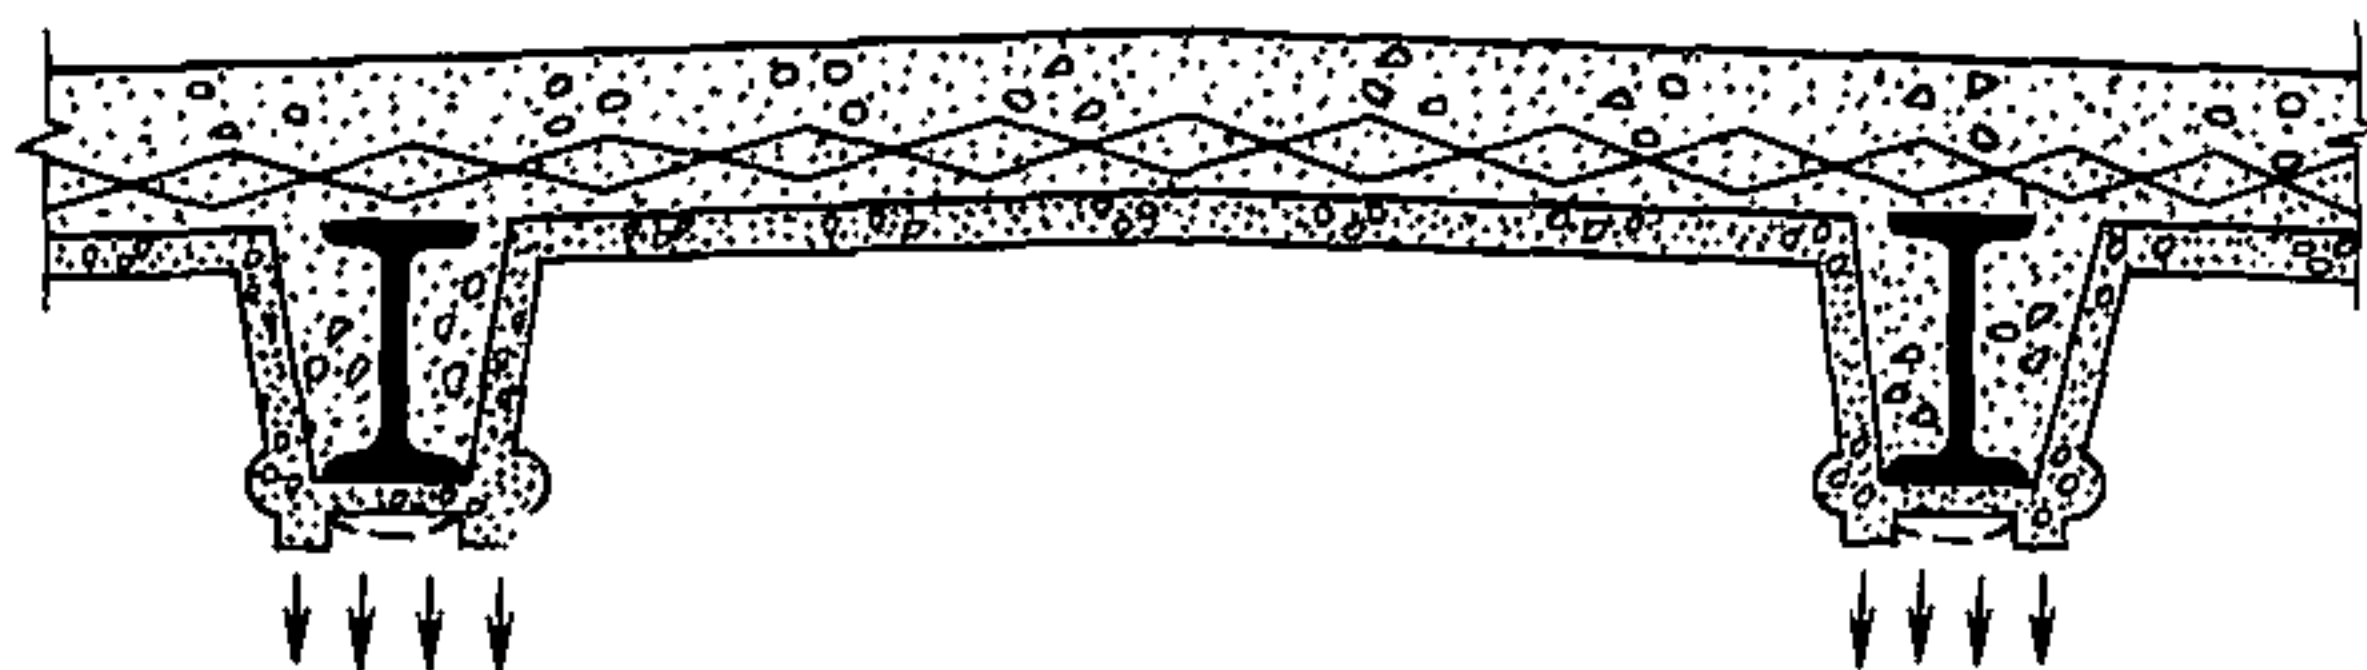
Повреждения в металлобетонном перекрытии (коррозия нижней полки двутавра)
